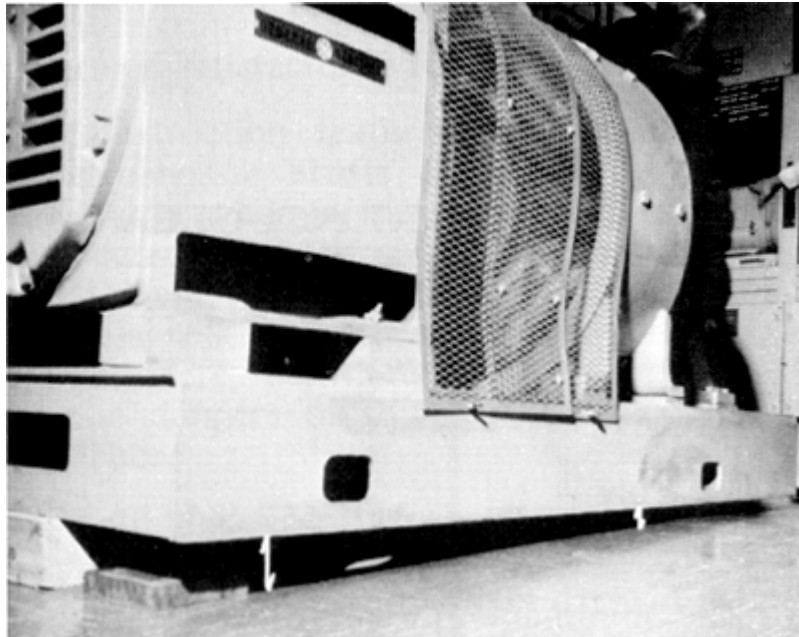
Recalage de générateurs nécessité par le soulèvement du plancher.
